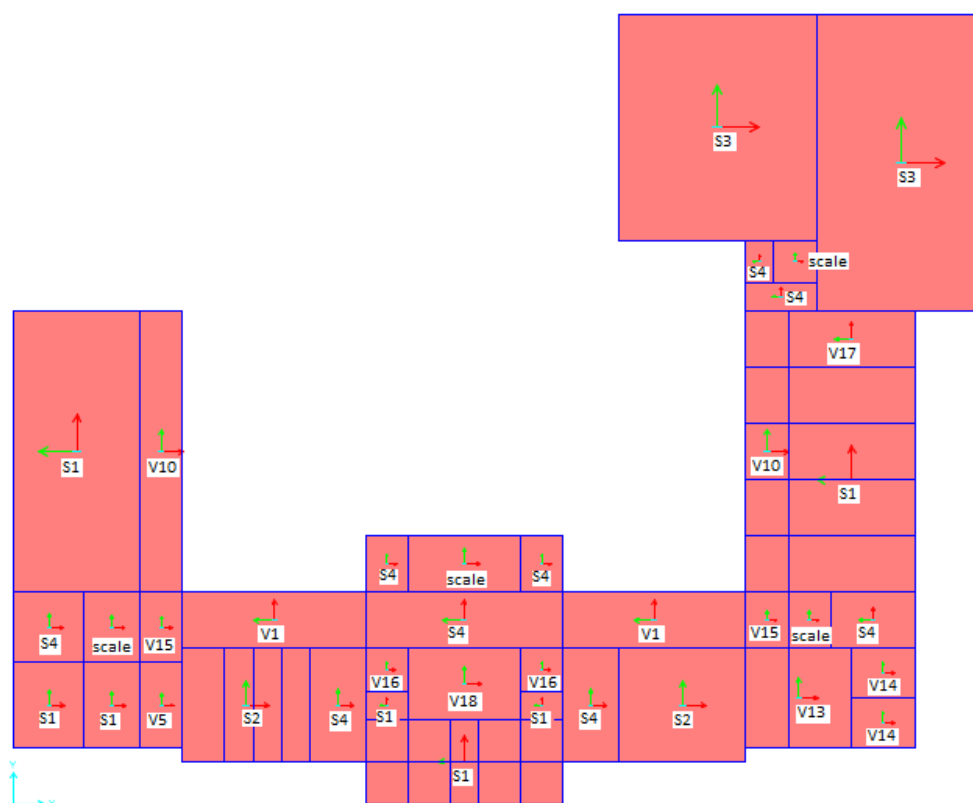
piano secondo/sottotetto – Quota 11,00 m
